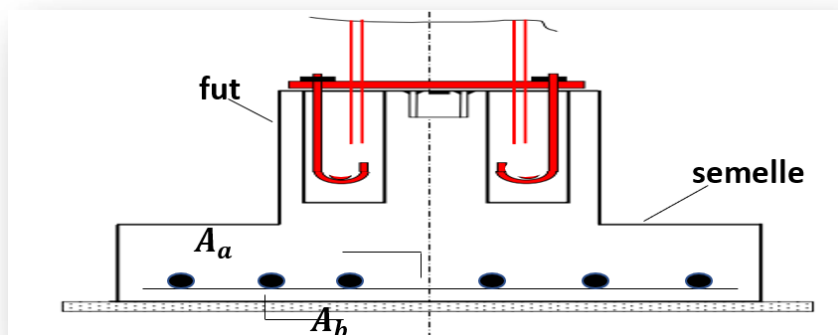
ferrailage des semelles isolées X.2.Calcul des longrines
